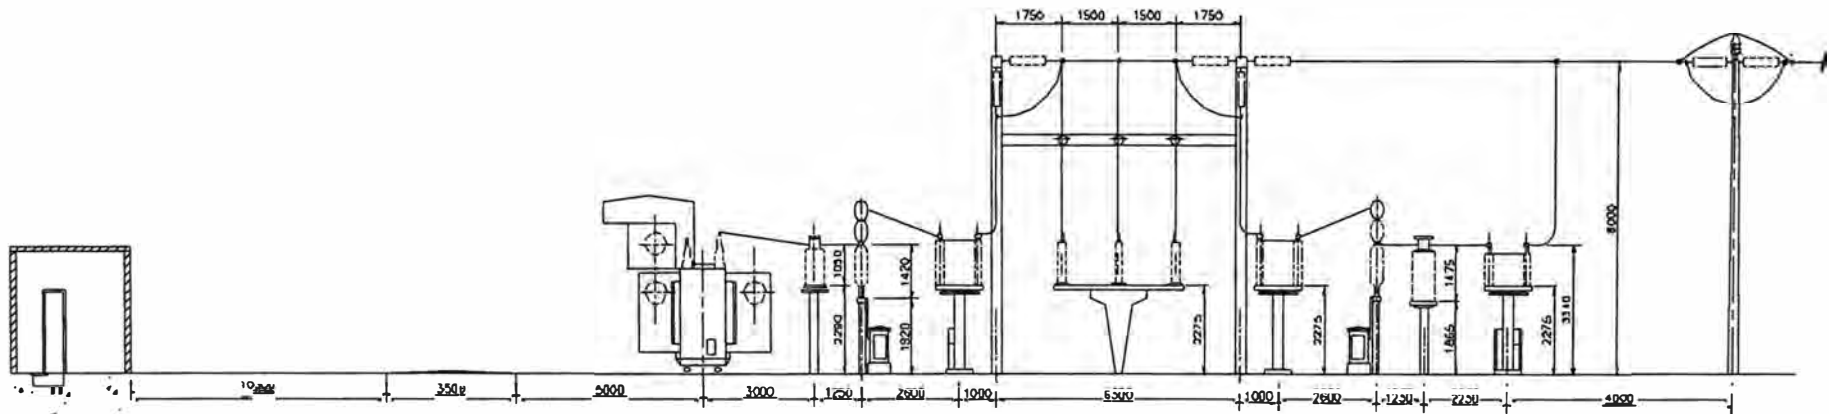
Vista transversal de una subestación AT/MT tipo exterior
